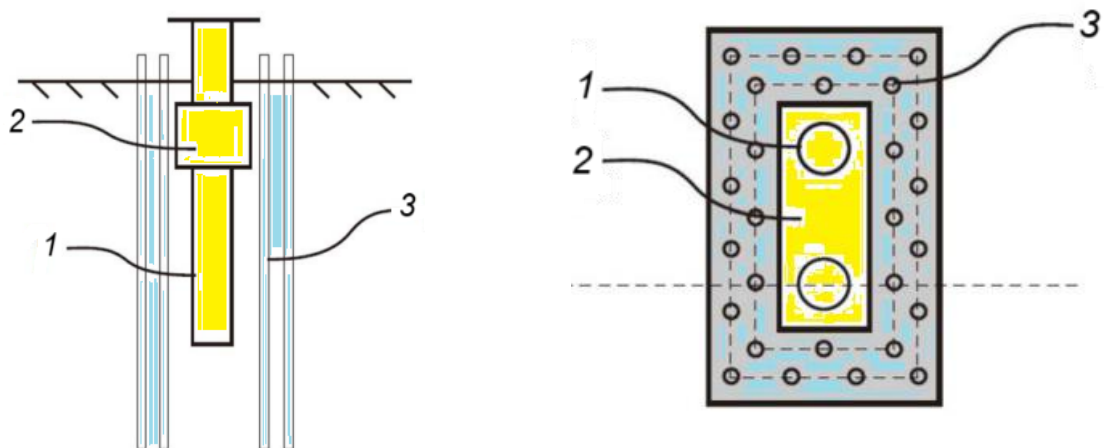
Підсилення експлуатованого пального фундаменту
